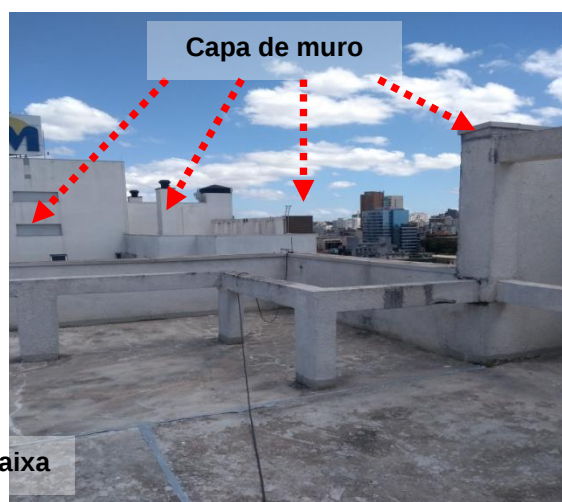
e 36: Malha captora instalada em perfil de alumínio, em volume mais elevado, junto às caixas d'água da edificação.
